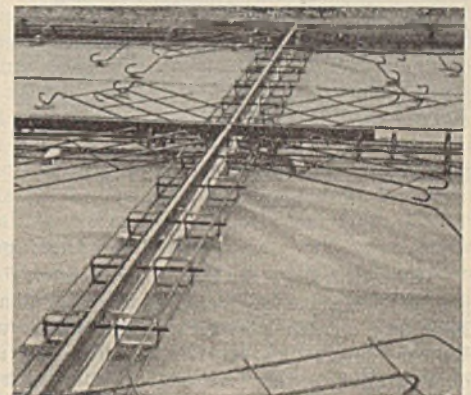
Dübeleinbau mit Hilfe der Randbewehrung.
